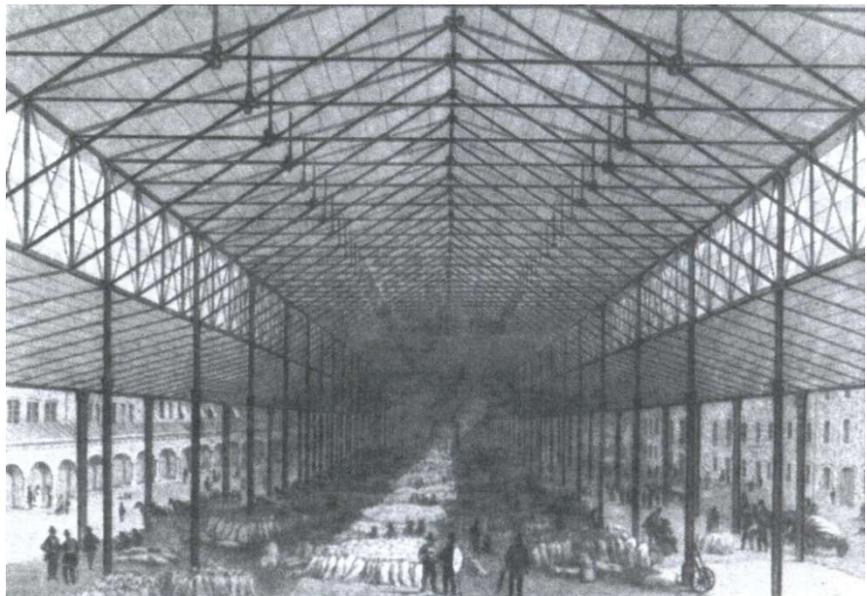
Innenansicht der Schrammenhalle um 1860 [22]
